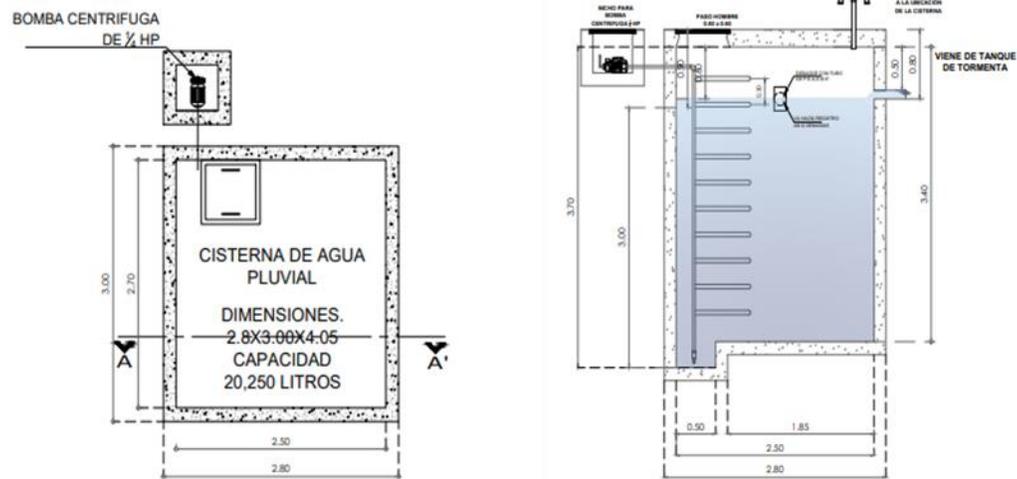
Cisterna de agua pluvial (vista en planta y en corte).
